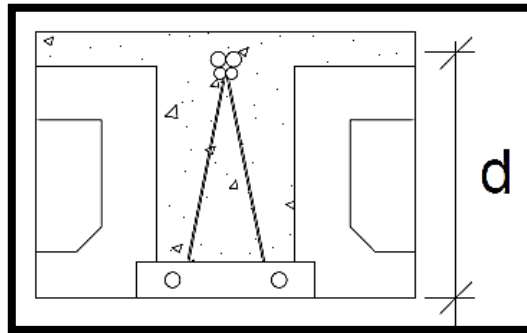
Sección de viga para el cálculo del peralte efectivo.
